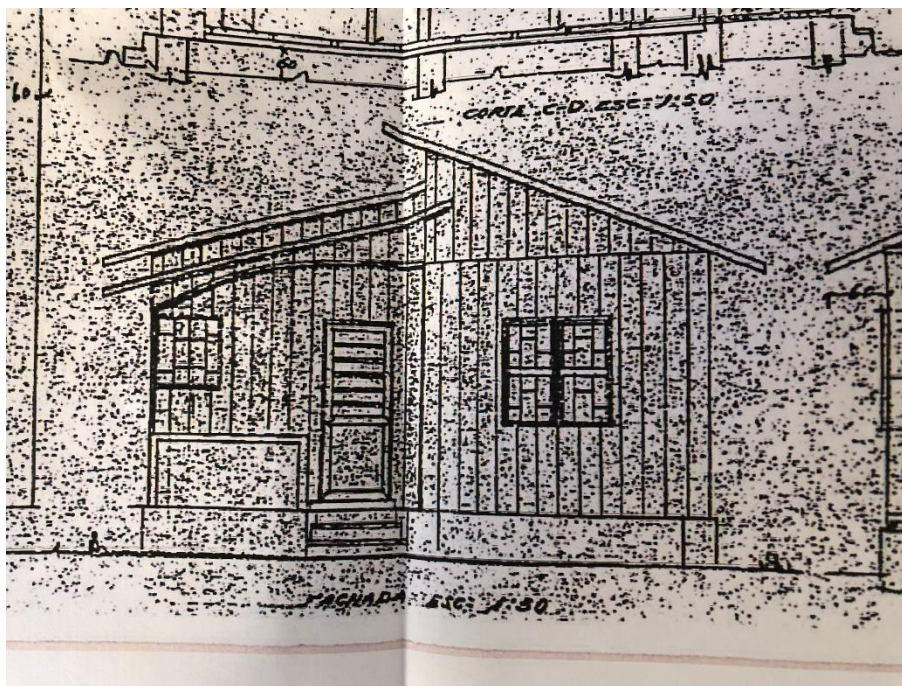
Fachada da edificação já demolida sobre o lote vistoriado. (Fonte própria)
